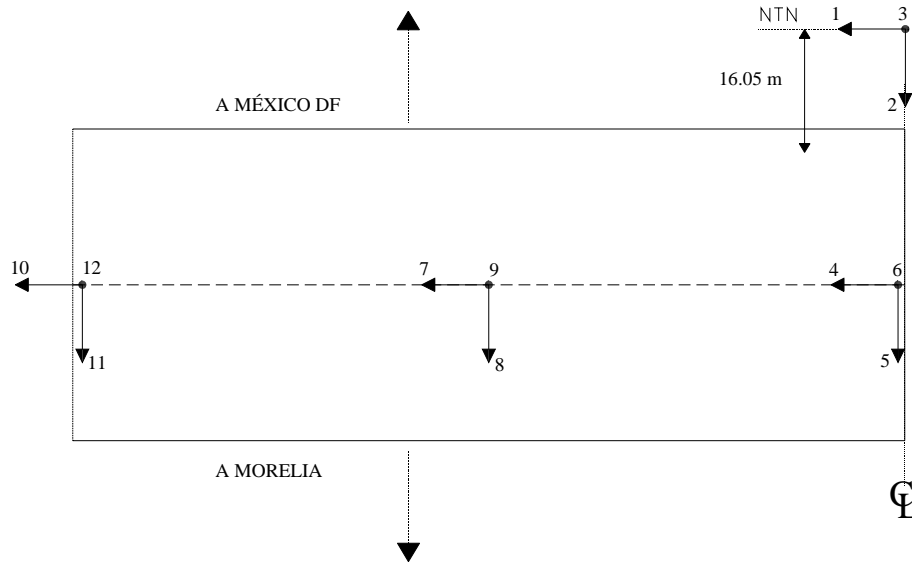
Distribución de sensores puente Maravatío kilómetro 157+496
